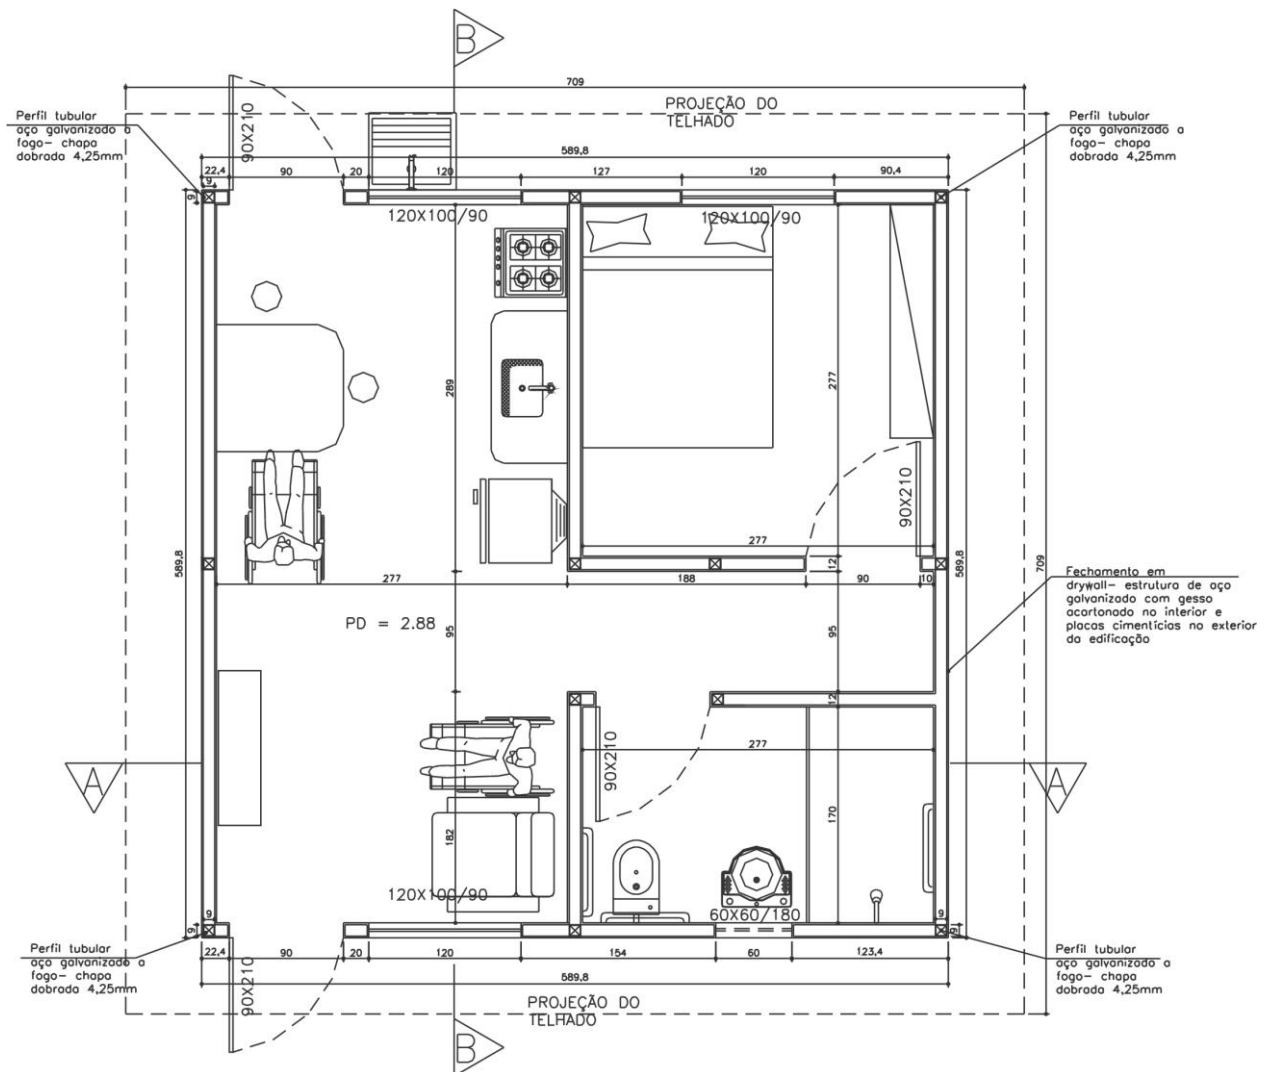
Planta – Modelo arquitetônico básico - HIS.
